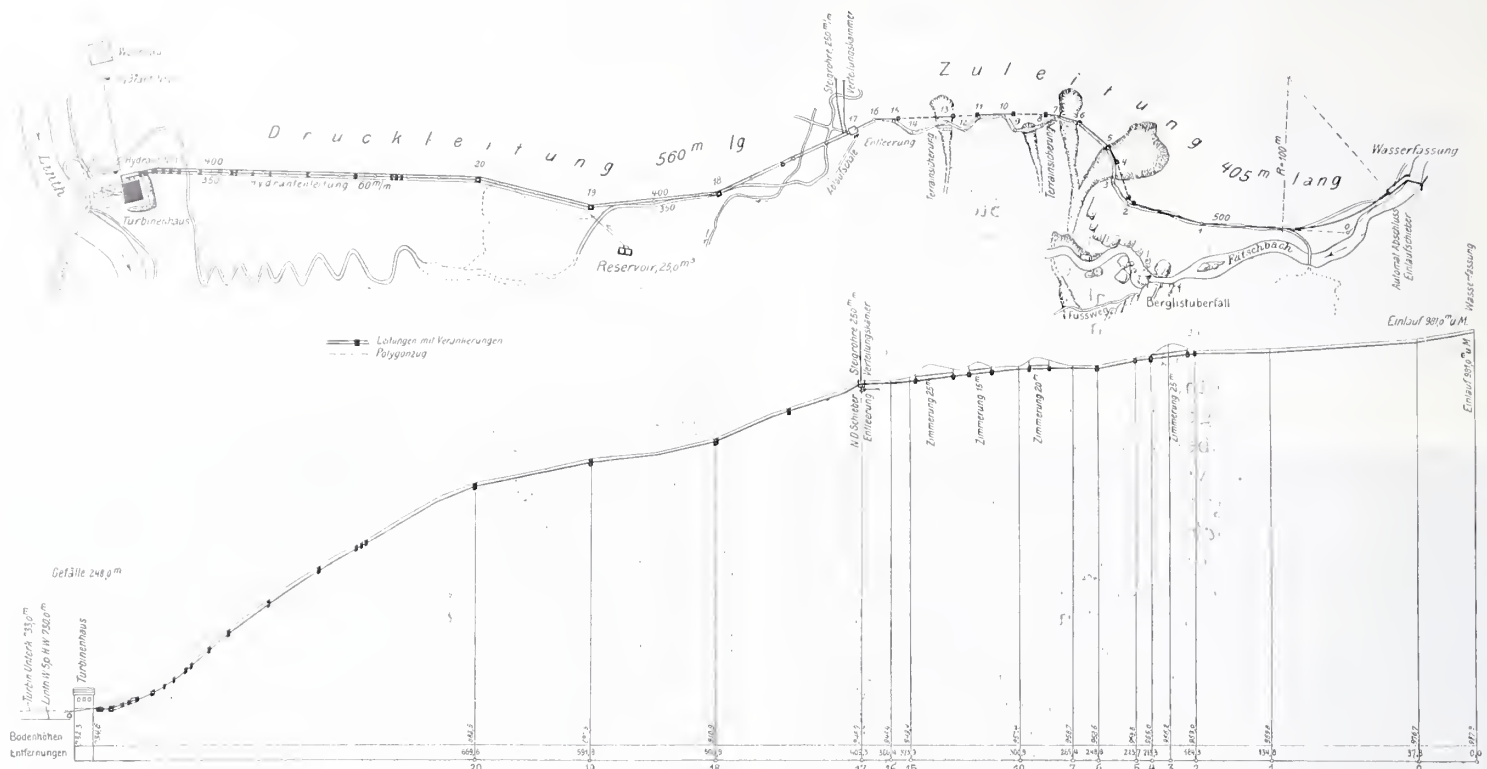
Lageplan und Längenprofil der Wasserkraftanlage für das Elektrizitätswerk Linth. — Masstab 1 : 5000.
